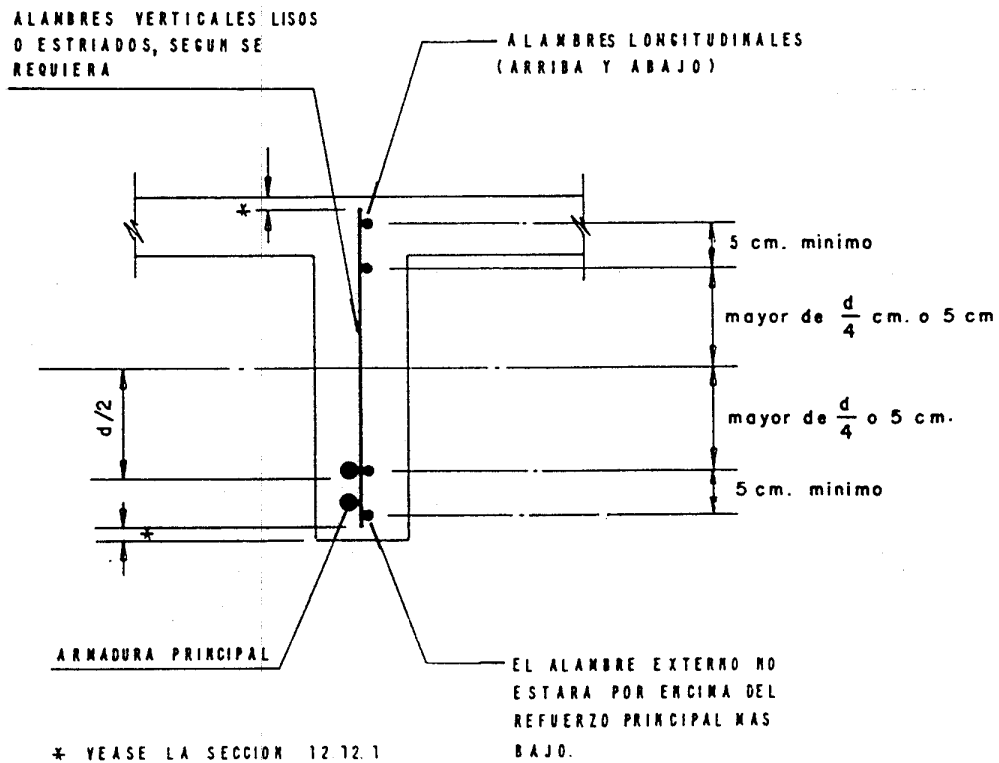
ANCLAJE DE LA ARMADURA DE CORTE DE ESTRIBOS DE UNA RAMA CONSTITUIDOS POR MALLA DE ALAMBRE SOLDADO.
